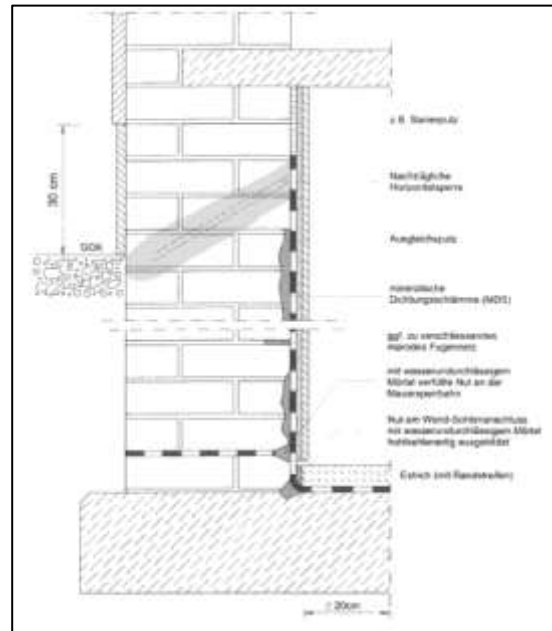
Prinzipieller Innenabdichtungsaufbau mit Anschlussdetails
